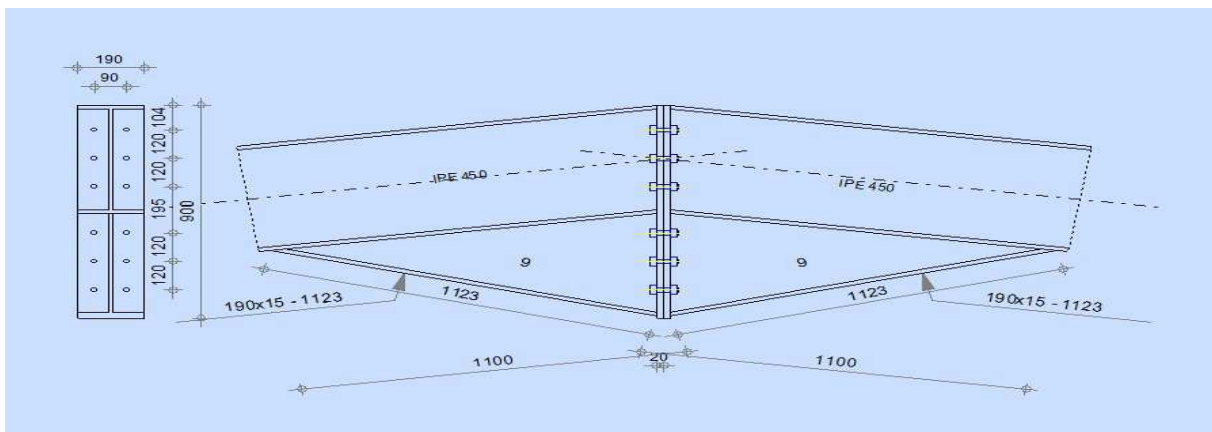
3: Vu en plan de l'assemblage traverse-traverse.
